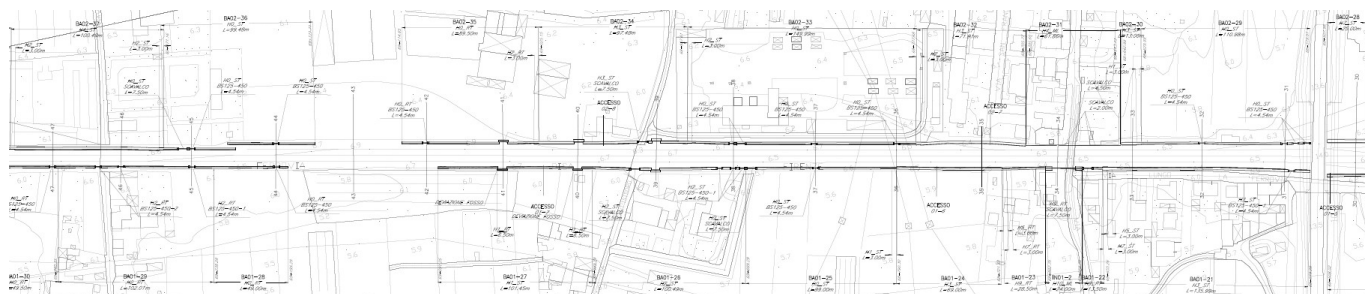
Stralcio planimetrico del tratto centrale dell'intervento - linea "Firenze - Pisa"
